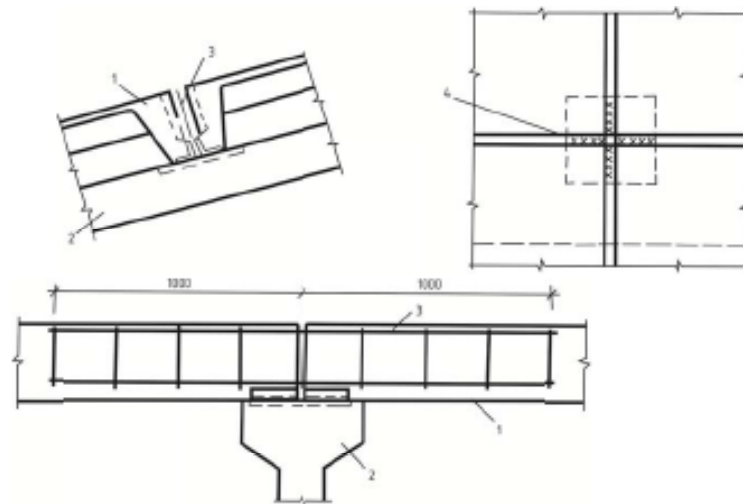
Усиление мест опирания плит покрытия на несущие покрытия.
